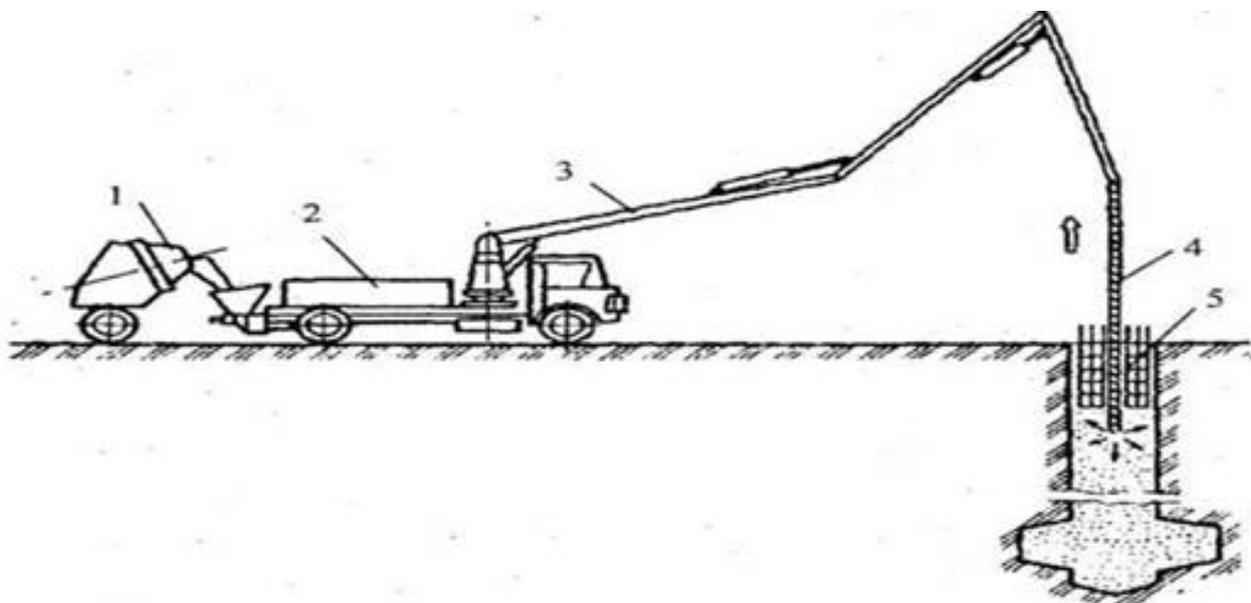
Бетонирование конструкций методом напорного бетонирования:
